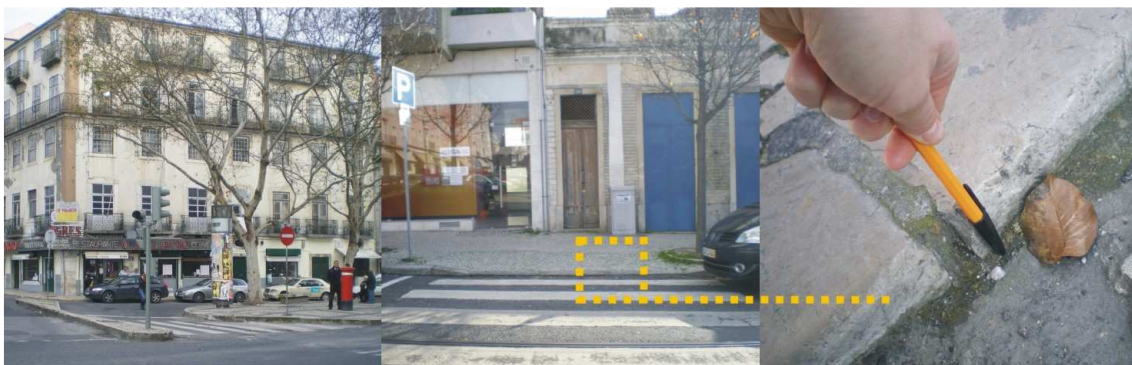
Atravessamentos não rebaixado e indevidamente rebaixado, percurso Estrela - Docas
